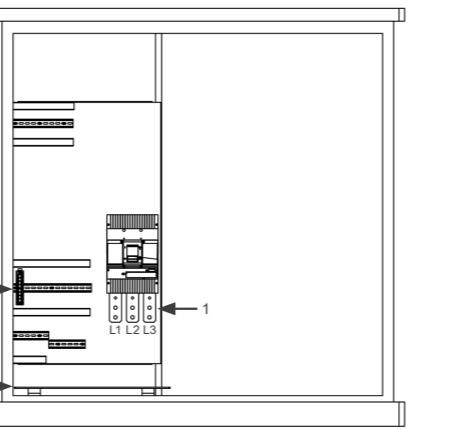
Conexiones de los cables de alimentación - Fases (L1-L2-L3) y puesta a tierra (PE)
